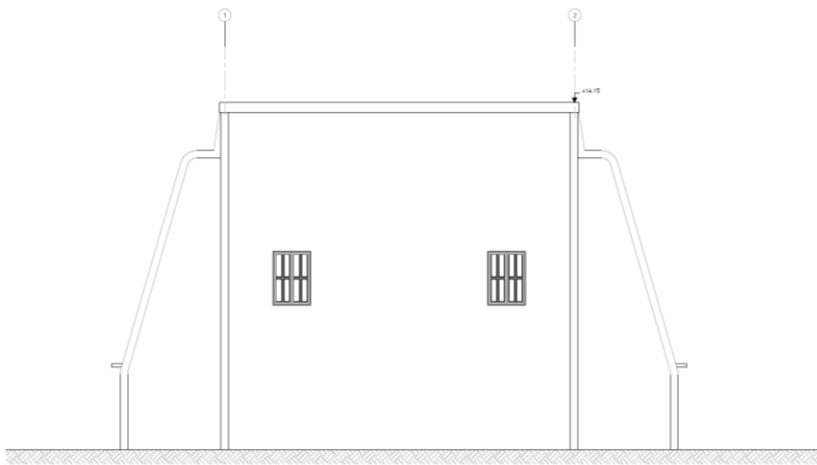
Alzado Oeste del Auditorio. Levantamiento realizado en el año 2019. Fuente: Autora. Ver Planos en los Anexos.
